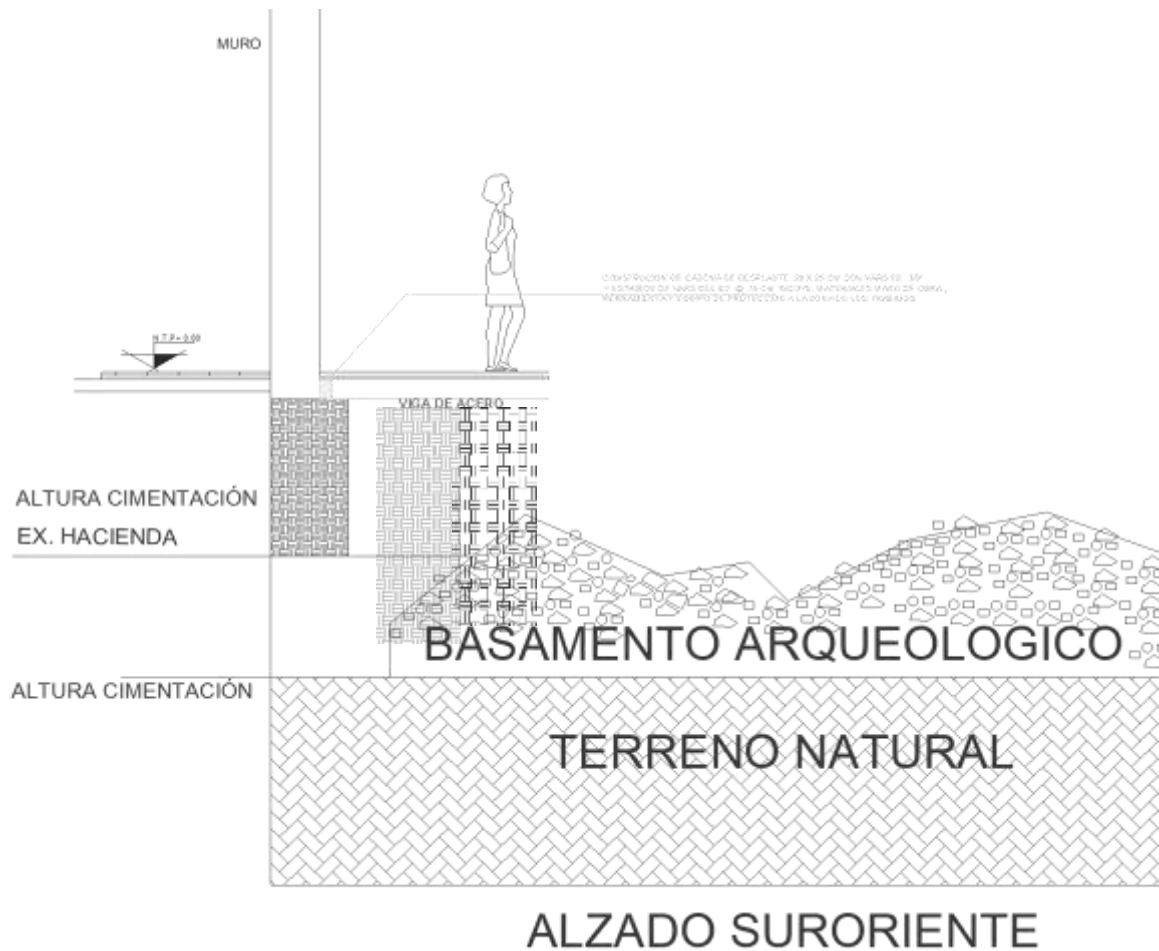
Alzado base Sur -Oriente, ubicación del basamento y alturas del mirador.
